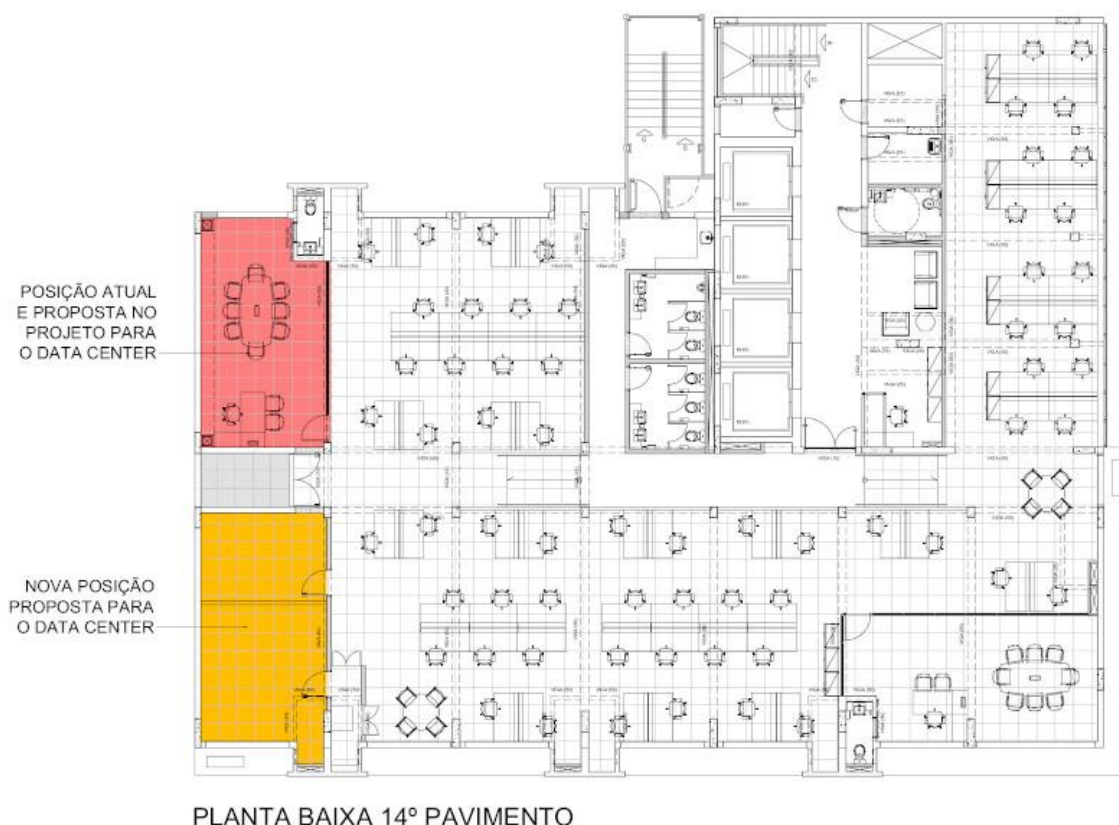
Planta 14º pavimento sede posição atual e proposta para novo Data Center.
